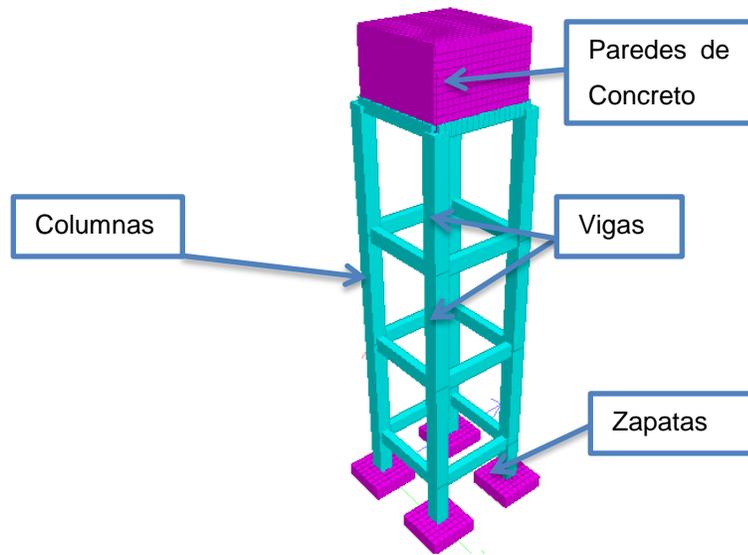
Modelo en Staad, Tanque Elevado 5,000 Galones
